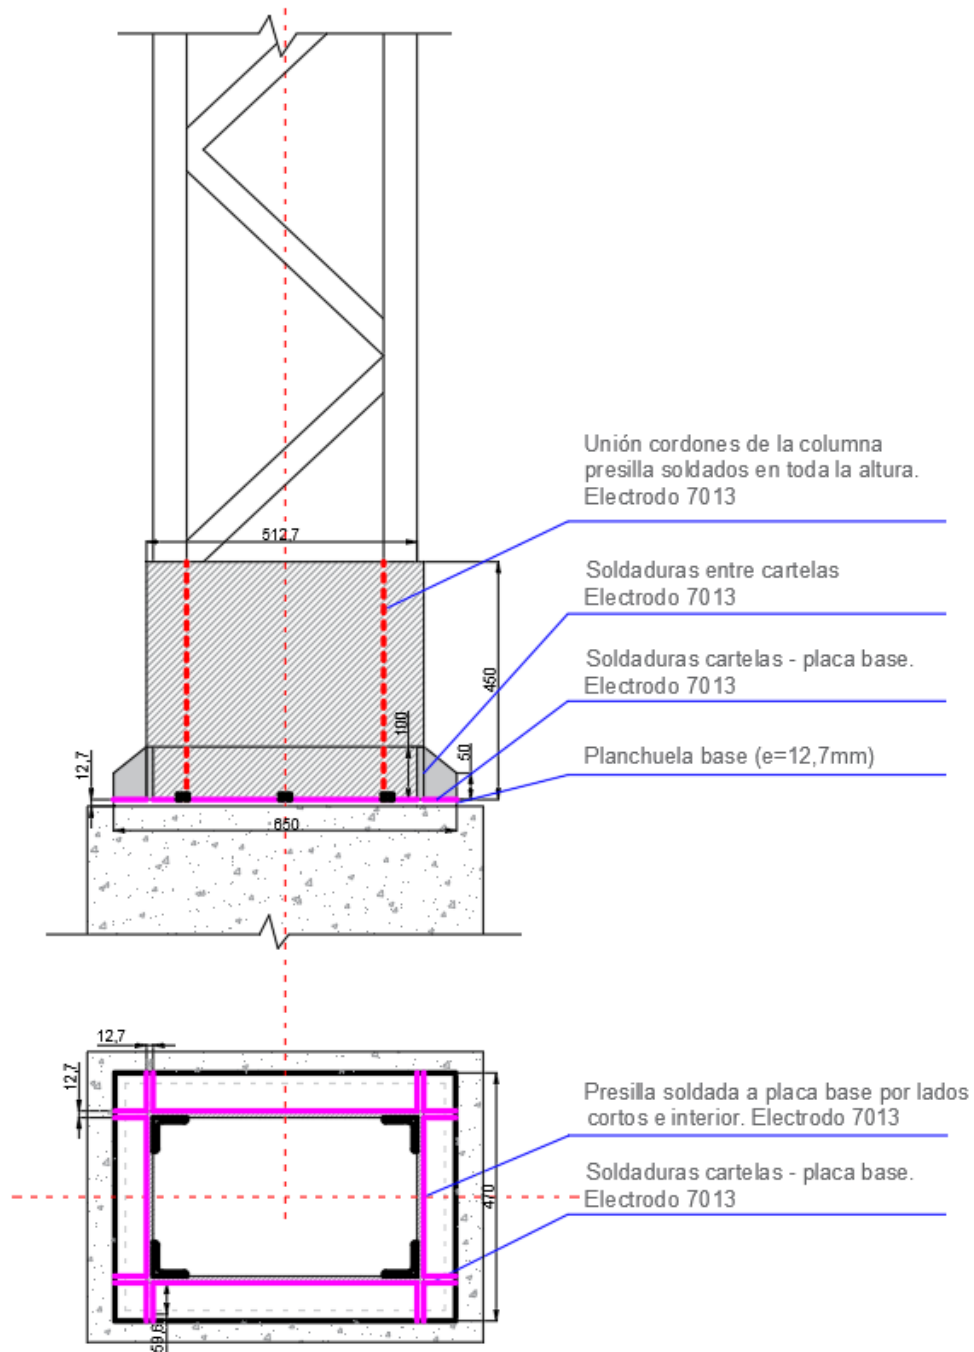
Detalle de soldaduras en unión Columna metálica - Tronco de columna de H*A
